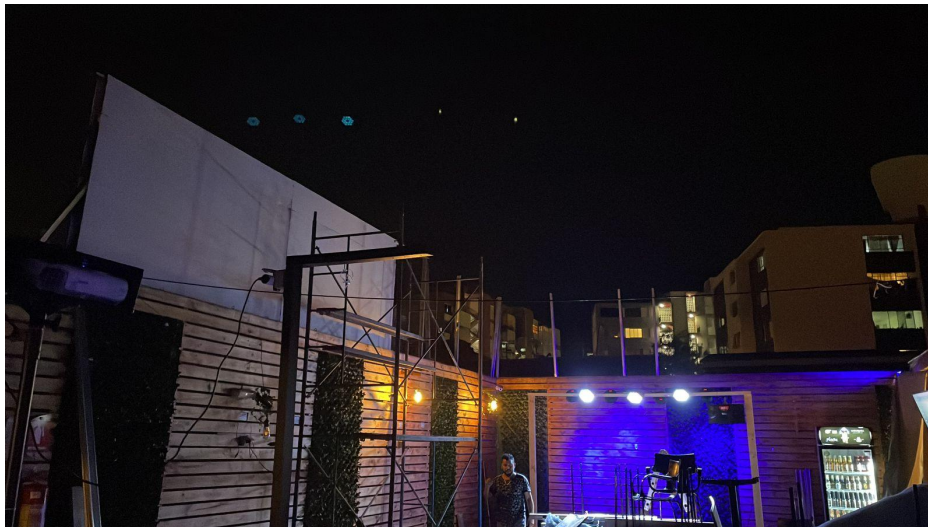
Avance levantamiento muros este y sur e instalación nuevo escenario
